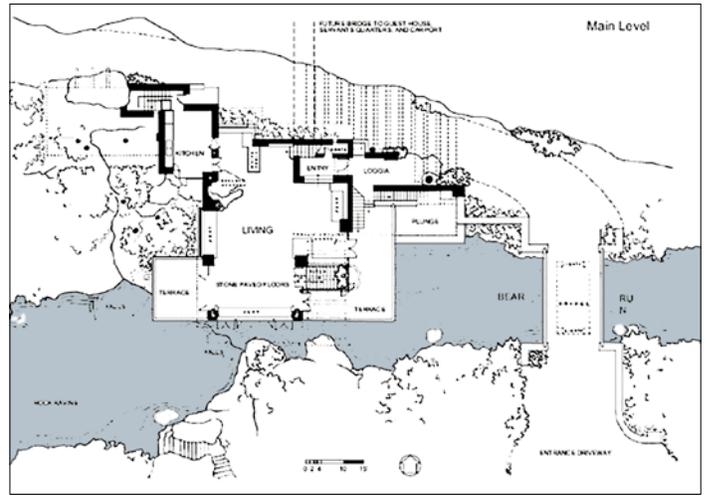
Casa de la Cascada. Planta baja. Fuente: <https://bit.ly/30Qhloq>.
